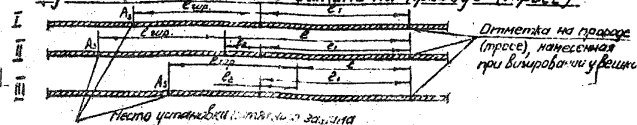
Нанесение отметок на проводах (тросе) при визиравании их без подвеса на анкерно-угловую опору.
